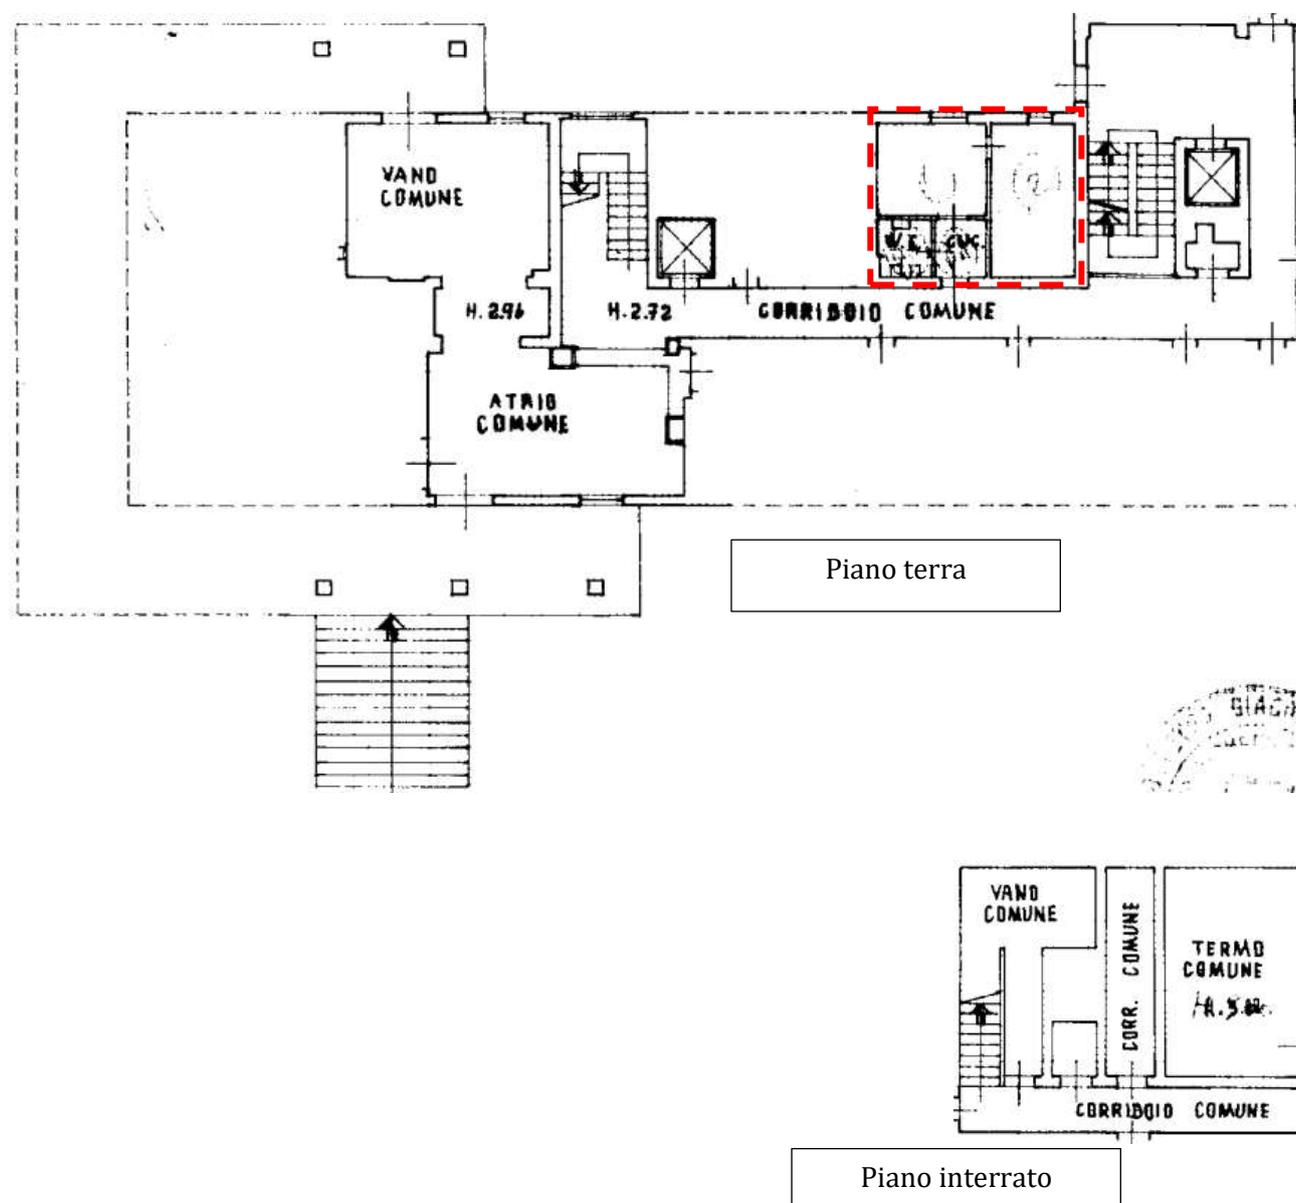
Estratto della planimetria catastale Piano Terra e interrato
